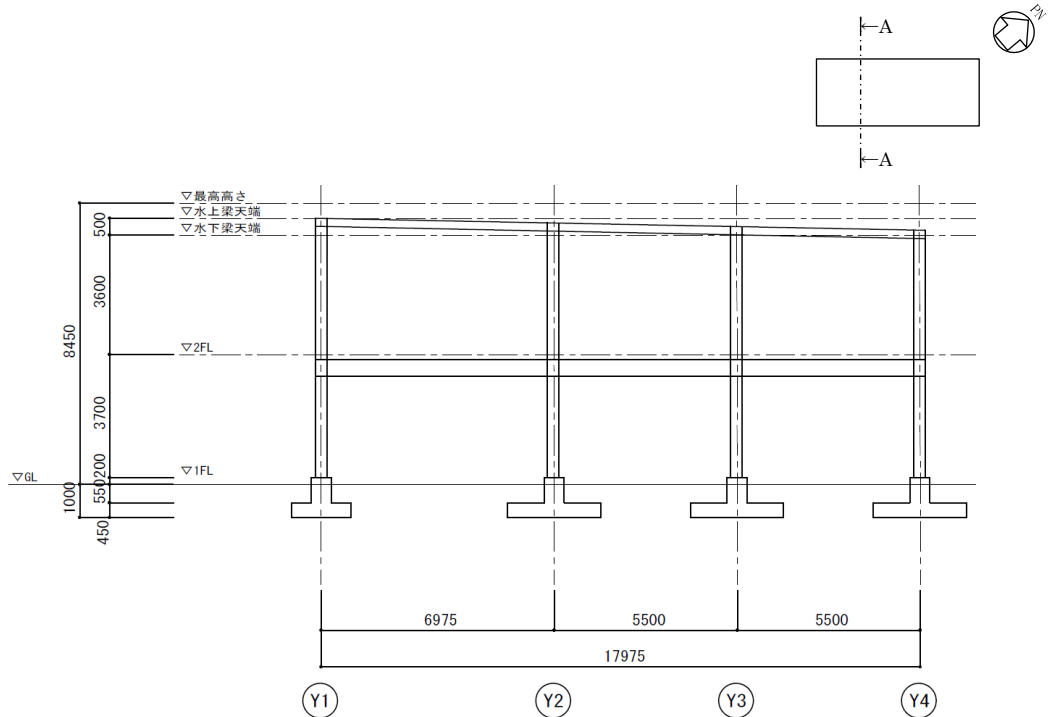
(3) 管理事務所 4 号館断面図 (A-A 断面)
